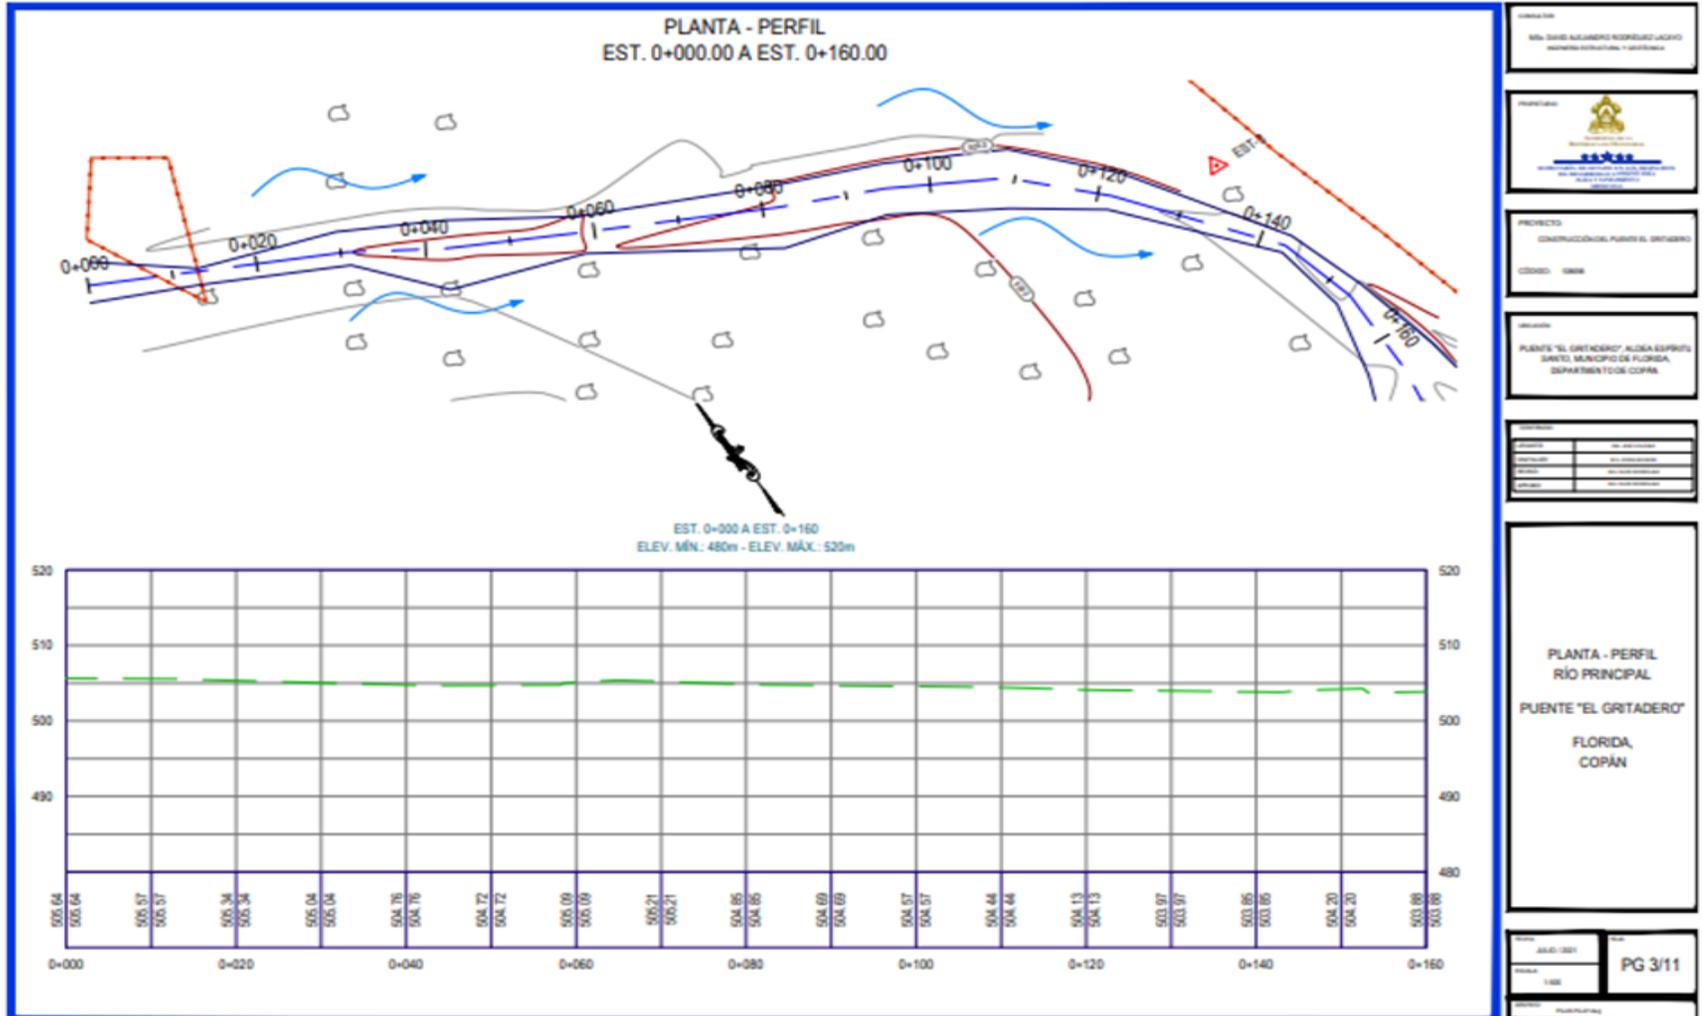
Planta Perfil estación 0+000 - +0+160
